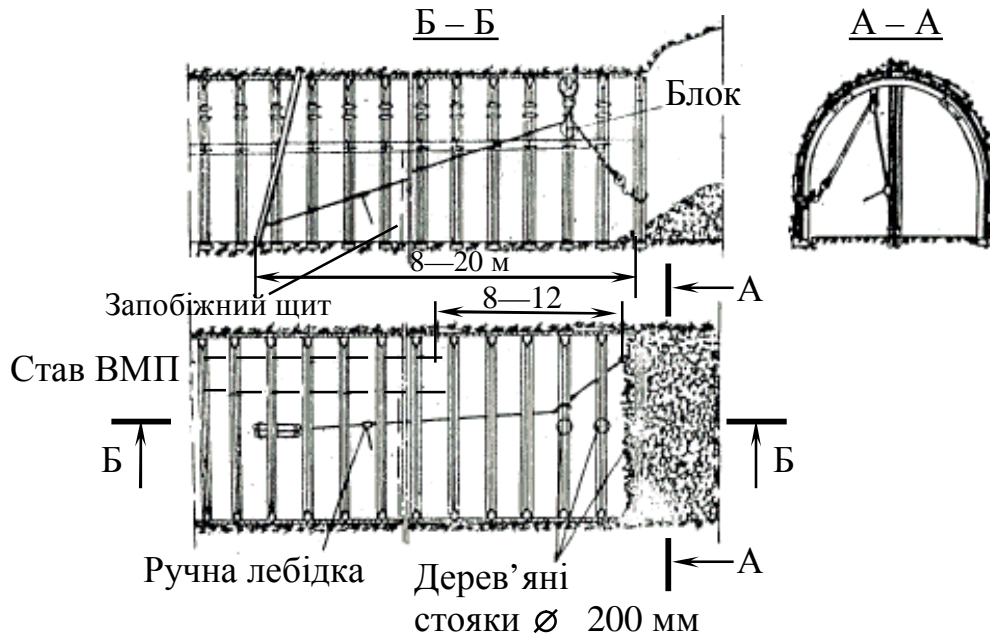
Схема витягання металевого кріплення з виробок, що погашаються (протяжних) за допомогою ручної лебідки
